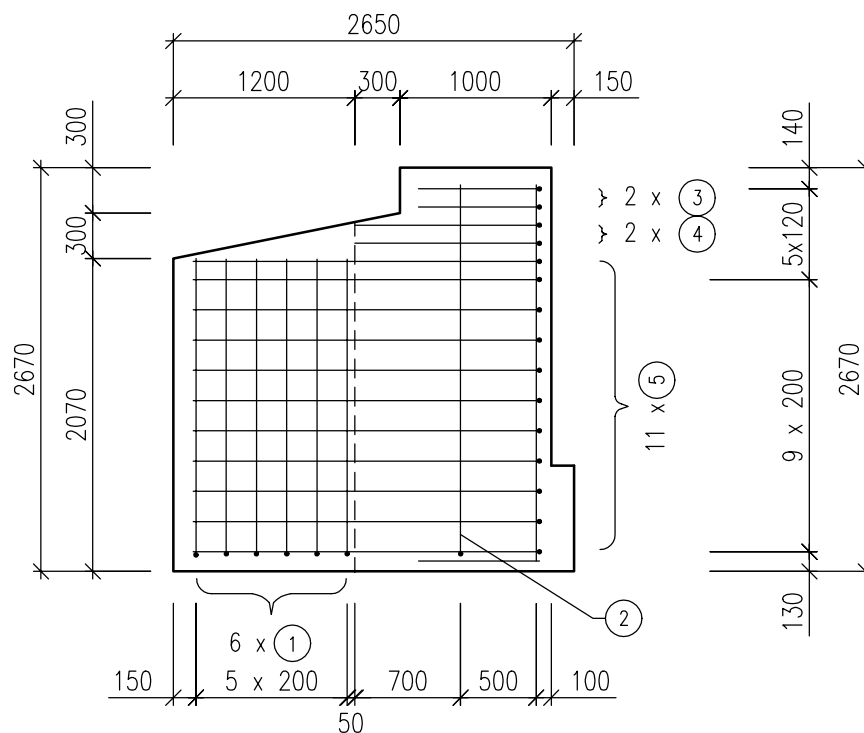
PŘÍKLAD BETONOVÉHO ZARÁŽEDLA TYP "DSB"
